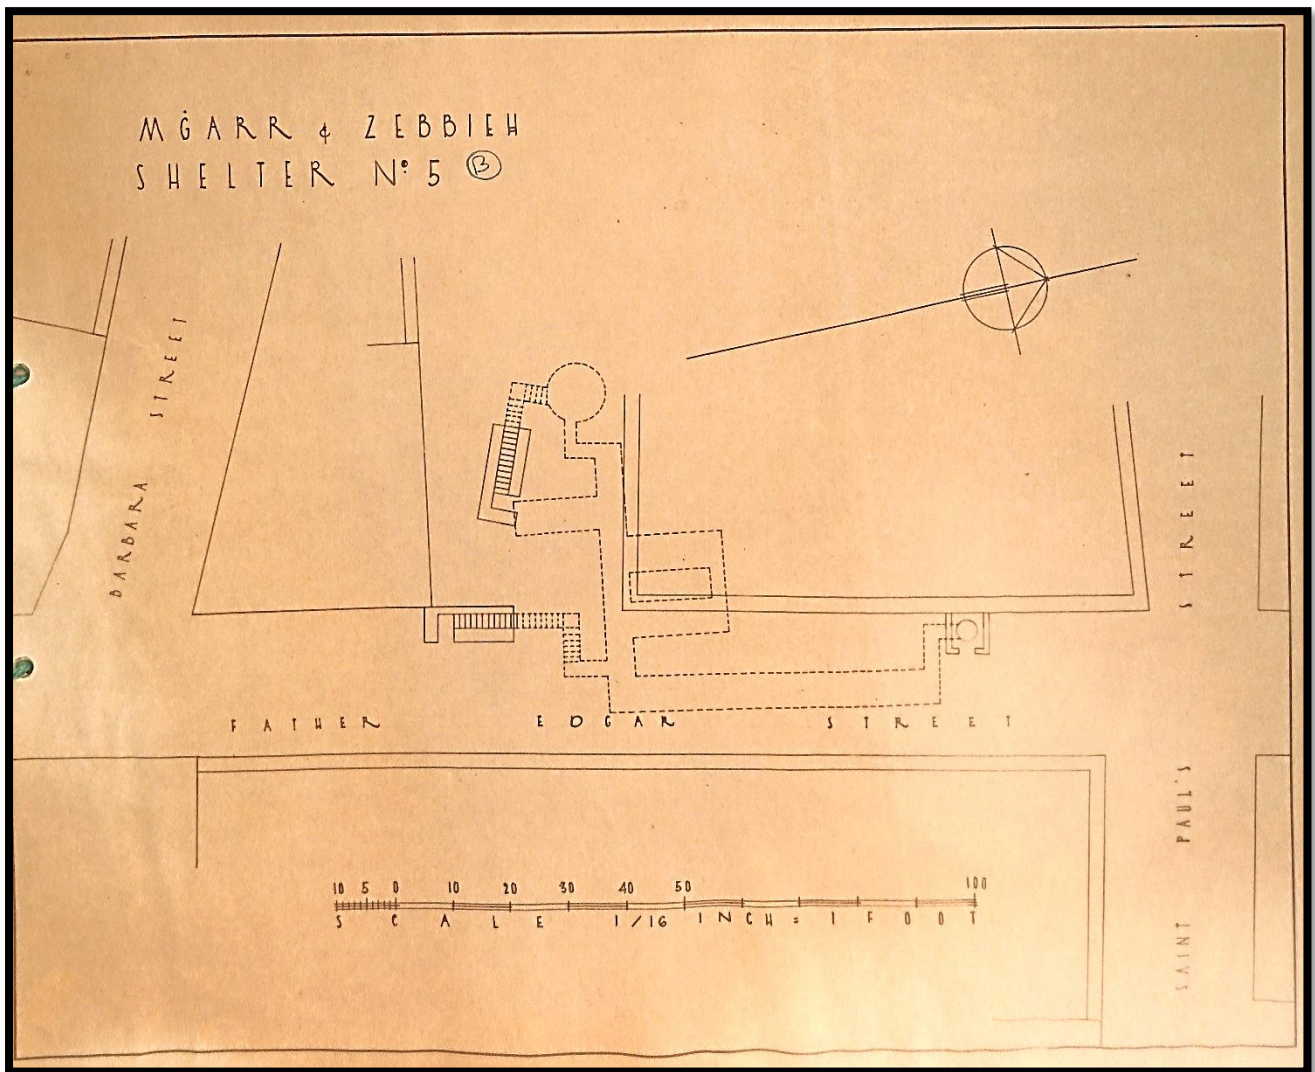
Planta do Abrigo nº5B "Father Edgar Street – Barbara Street – Sait Paul's Street."
